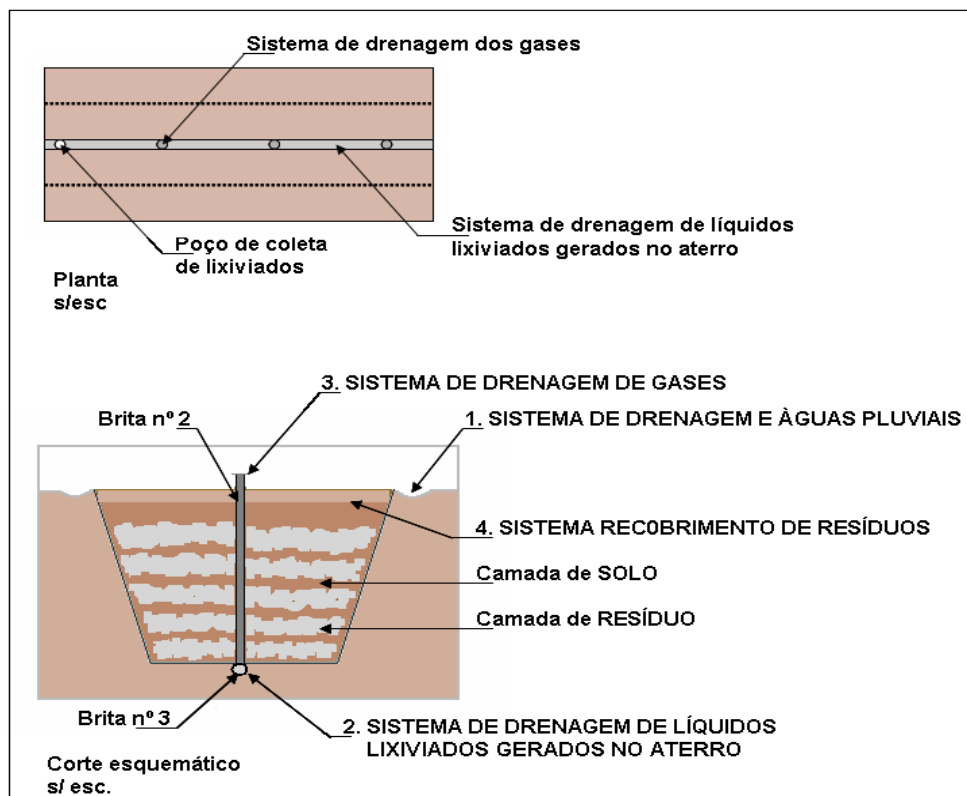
Esquema em planta e corte (s/esc.) dos sistemas de tratamento.
